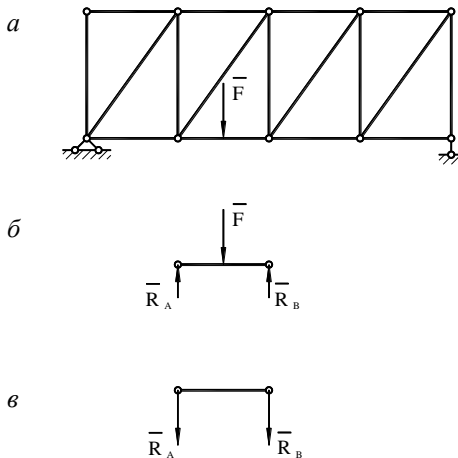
Ферма с внеузловой передачей нагрузки
